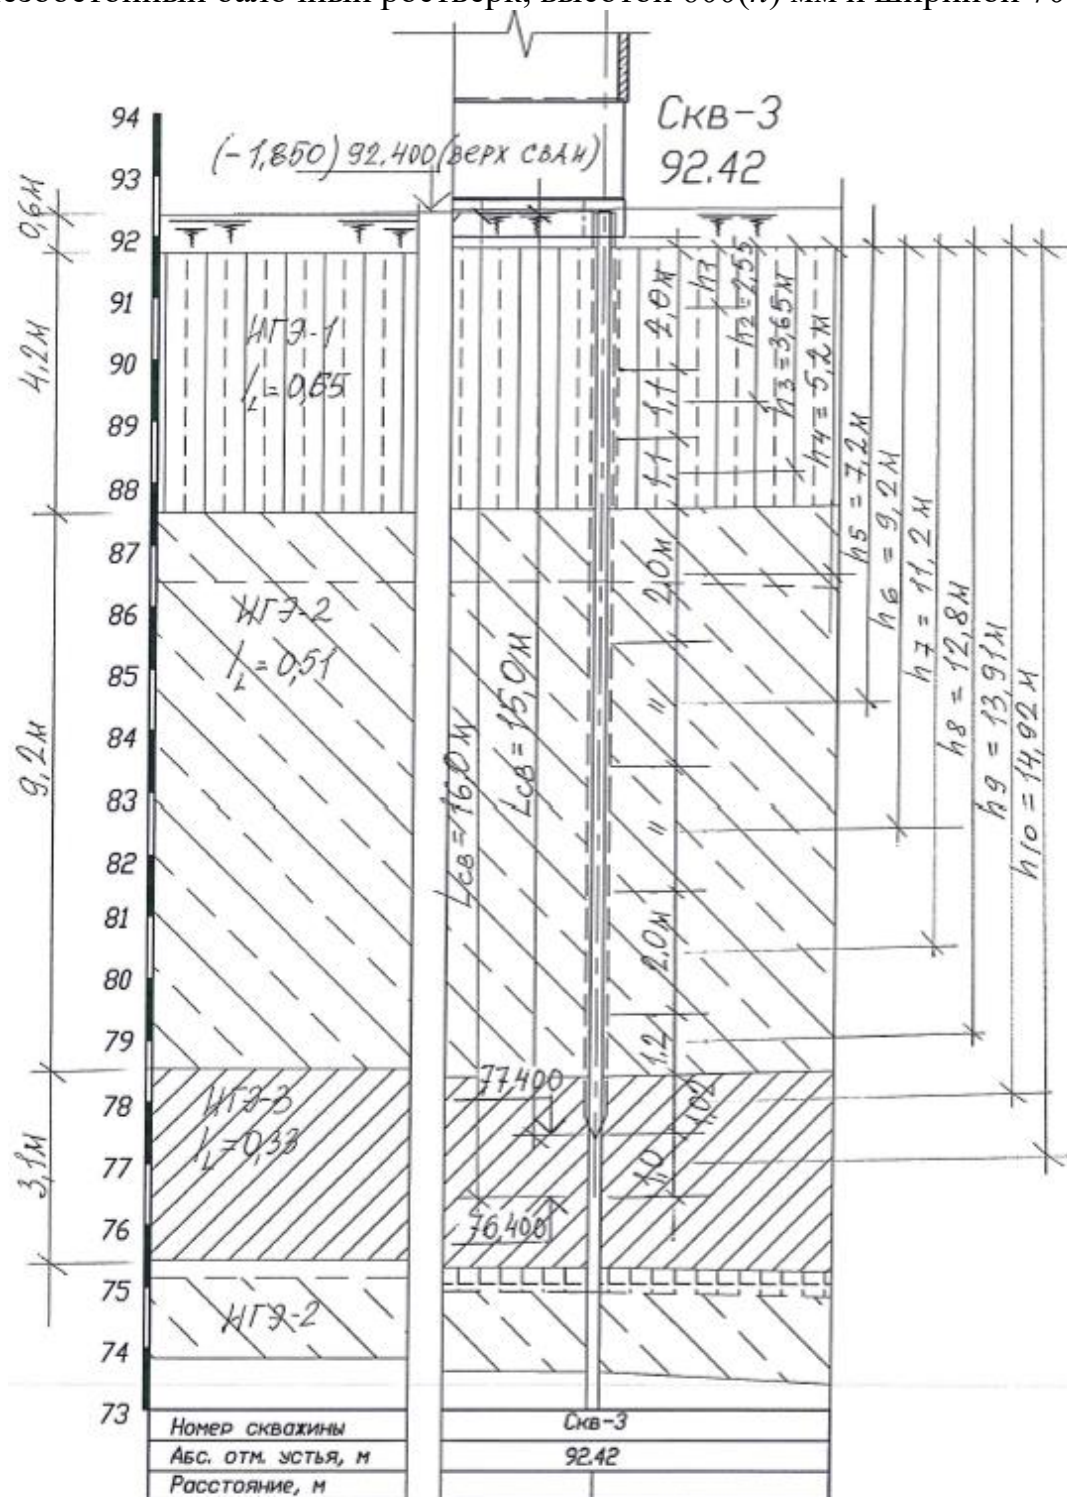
Инженерно-геологический разрез проектируемого фундамента
